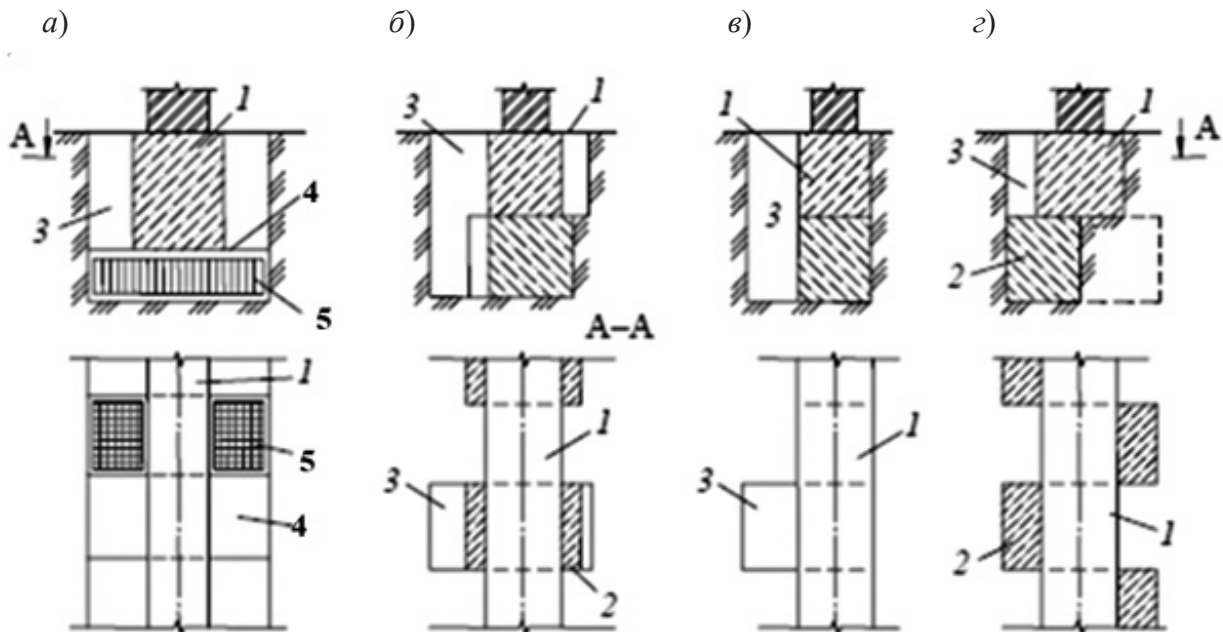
Варианты усиления фундаментов подведением под них дополнительных конструкций в виде [6]: *a* – монолитных железобетонных плит; *б, в* – дополнительных отдельных усиливающих столбов; *г* – сплошной стены; *1* – существующий фундамент; *2* – уширение подошвы дополнительным фундаментным блоком; *3* – шурф; *4* – прижимная плита; *5* – объединяющий монолитный армопояс
